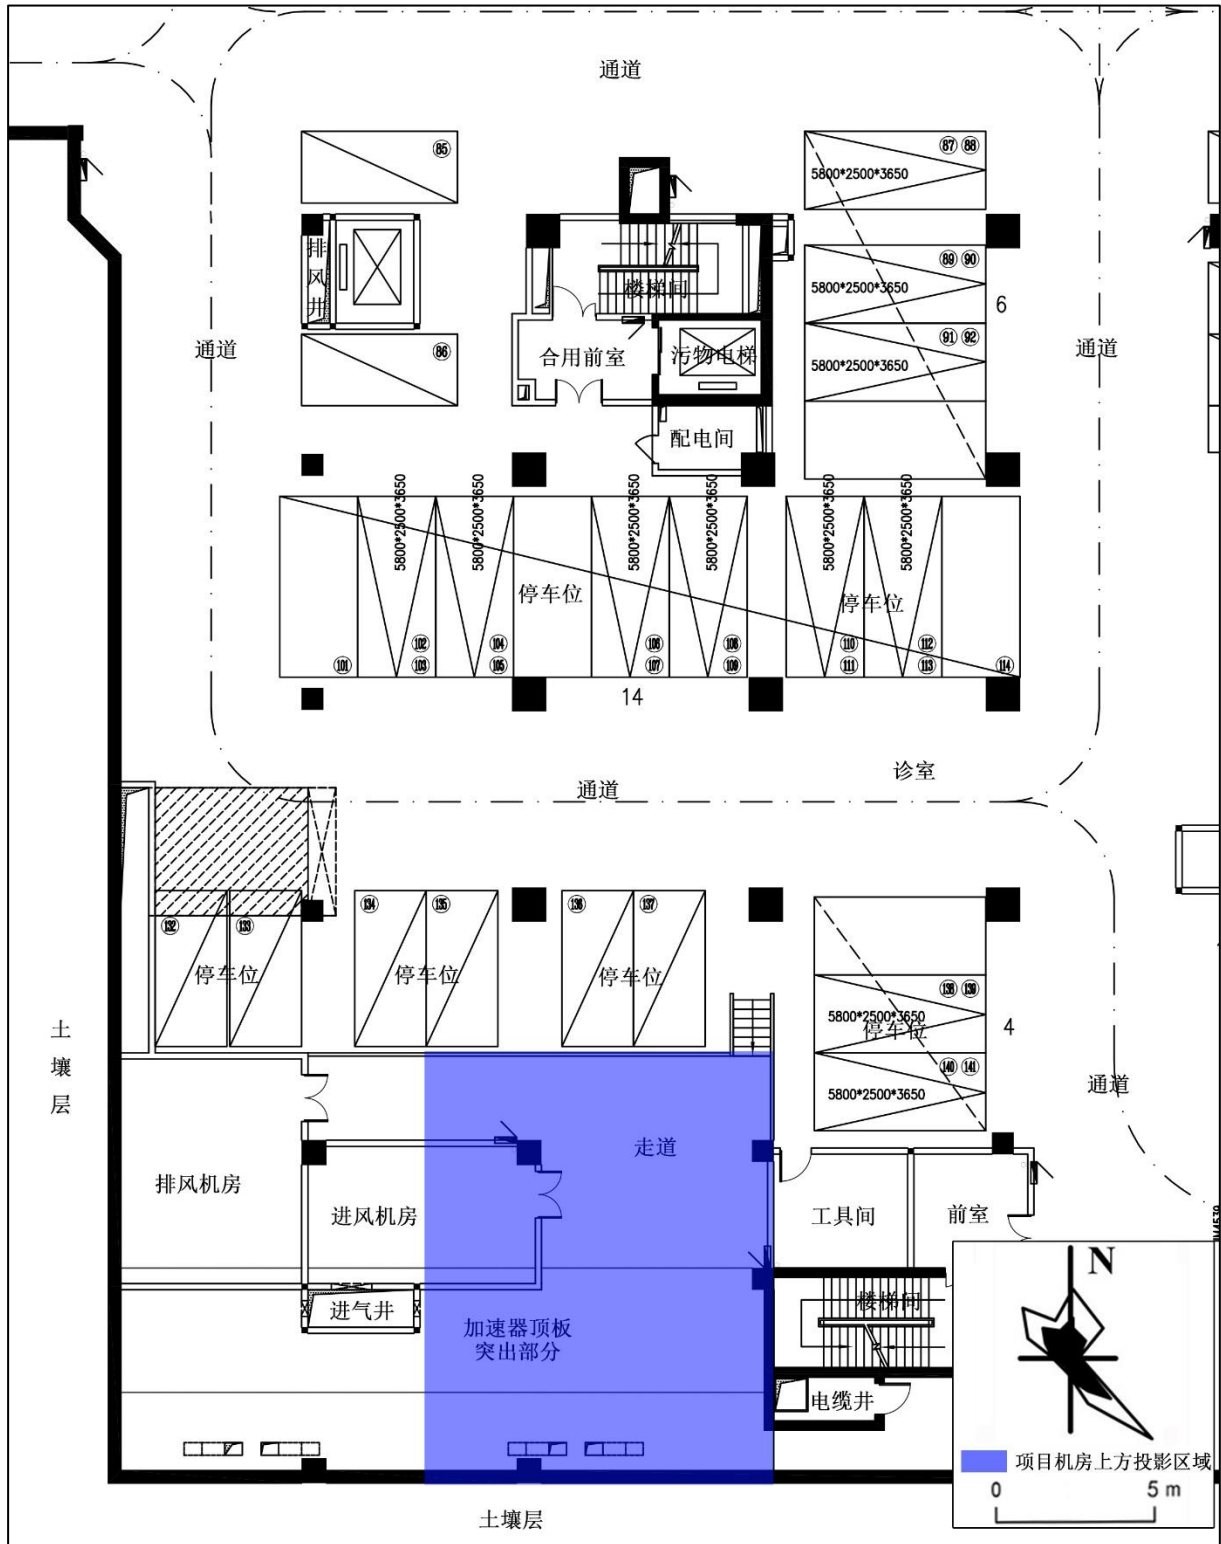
福建省立医院 6 号楼负 2 楼局部平面图
